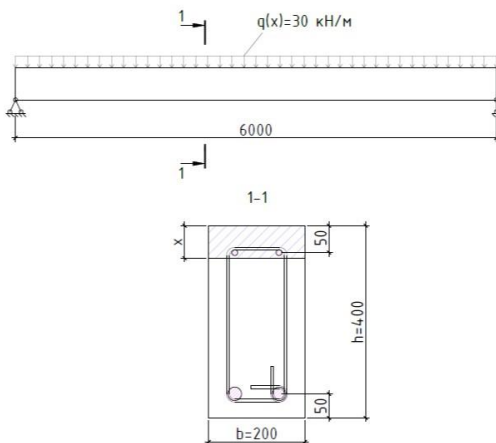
Расчетная схема, сечение и параметры армирования балки
